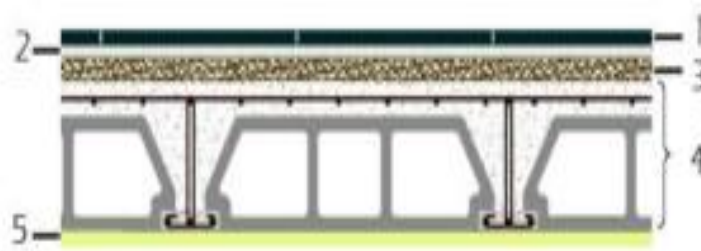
Coupe du plancher de l'étage courant en corps creux.
